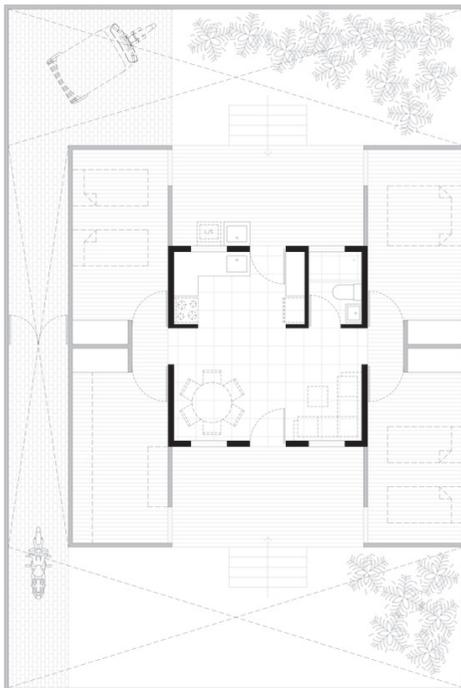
Planta baja, vivienda unifamiliar 2 pisos
